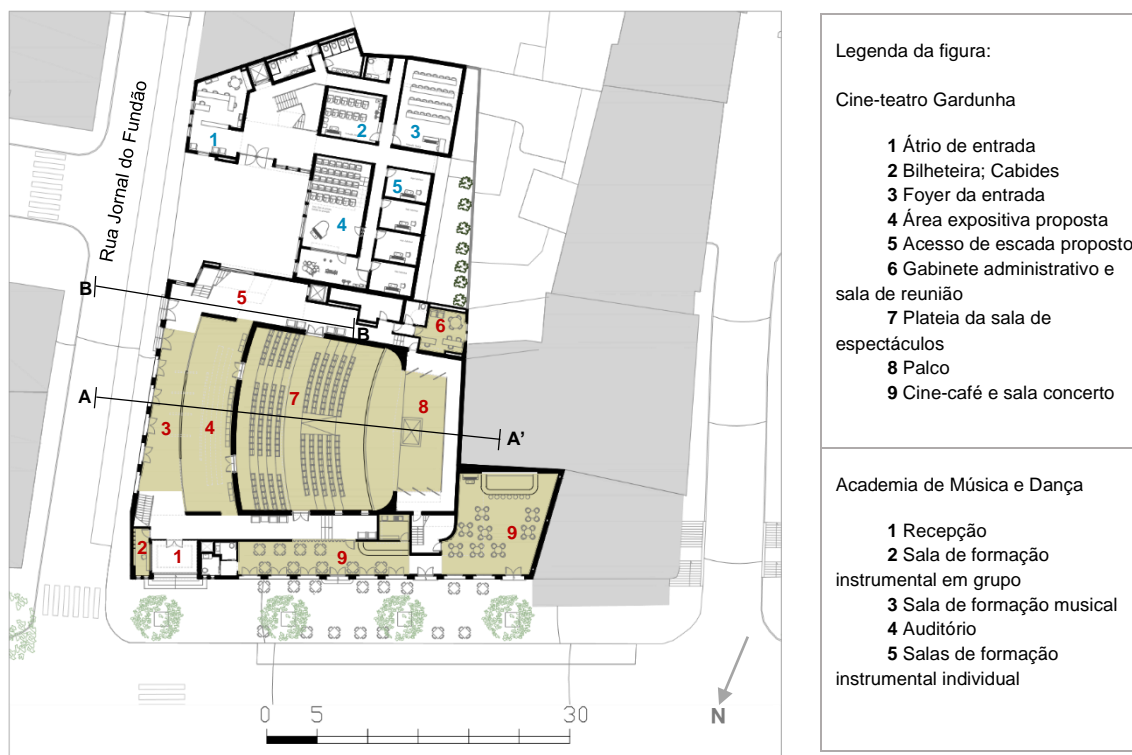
Planta do piso térreo da proposta para o Cine-teatro Gardunha e Academia de Música e Dança do Fundão.
